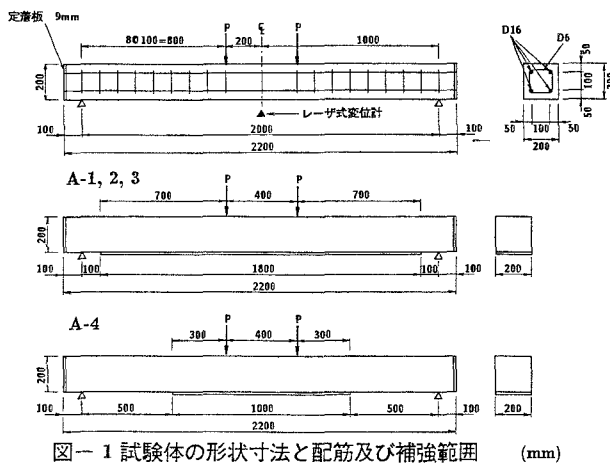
試験体の形状寸法と配筋及び補強範囲 (mm)
